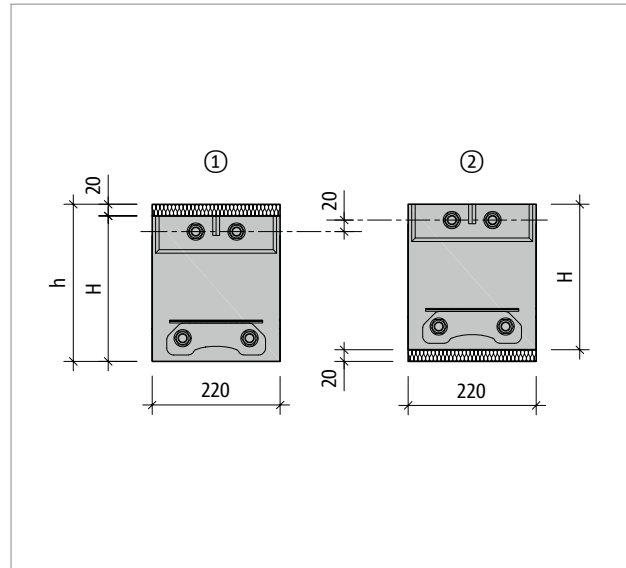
Schöck Isokorb® XT type SK : disposition avec décalage en hauteur
